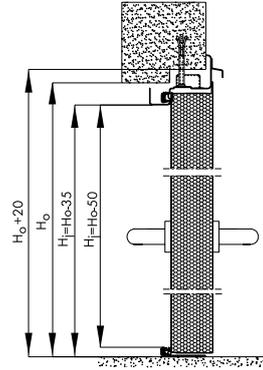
Montage einflügeliger Türen mit Eckzarge an der Mauer - Vertikalschnitt.
